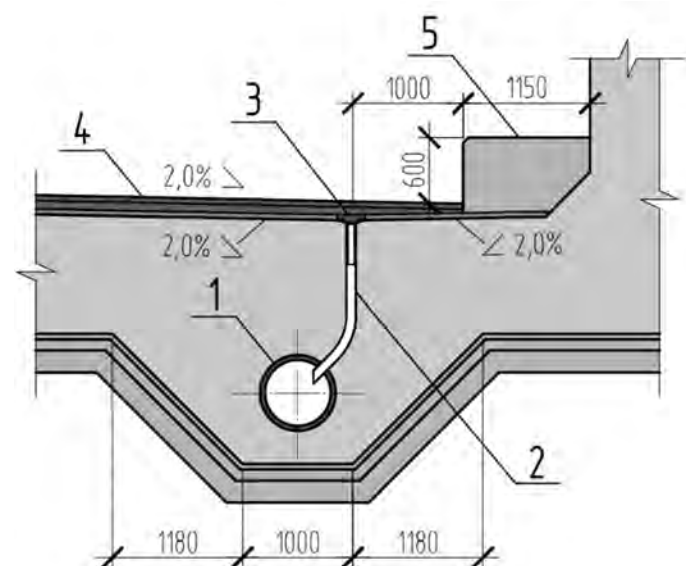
Узел устройства дренажа из-под дорожной одежды в тоннелях: 1 – водоотводная труба; 2 – дренажная трубка; 3 – дренажная щебеночная смесь; 4 – асфальтобетонное покрытие; 5 – технический тротуар
